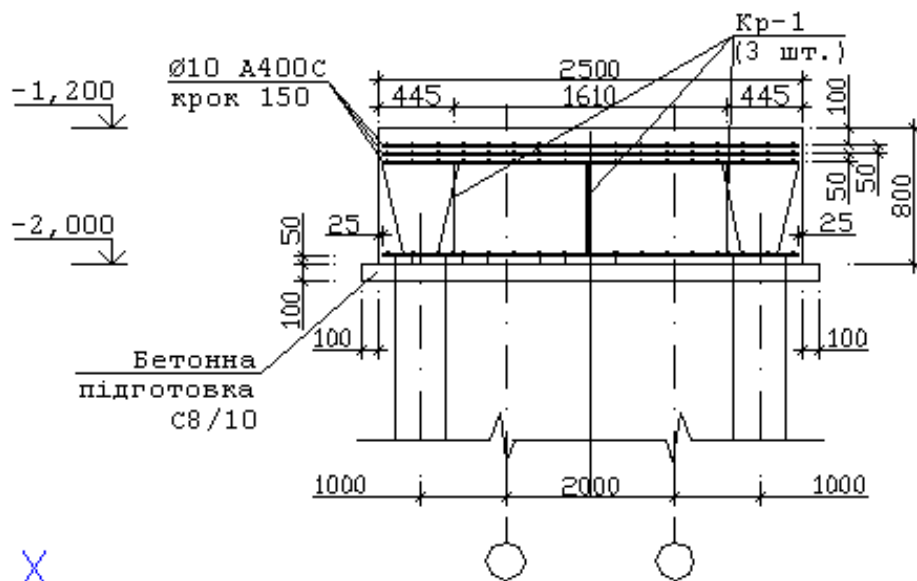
Схема армування монолітного залізобетонного ростверка (варіант із чотирма палями)
